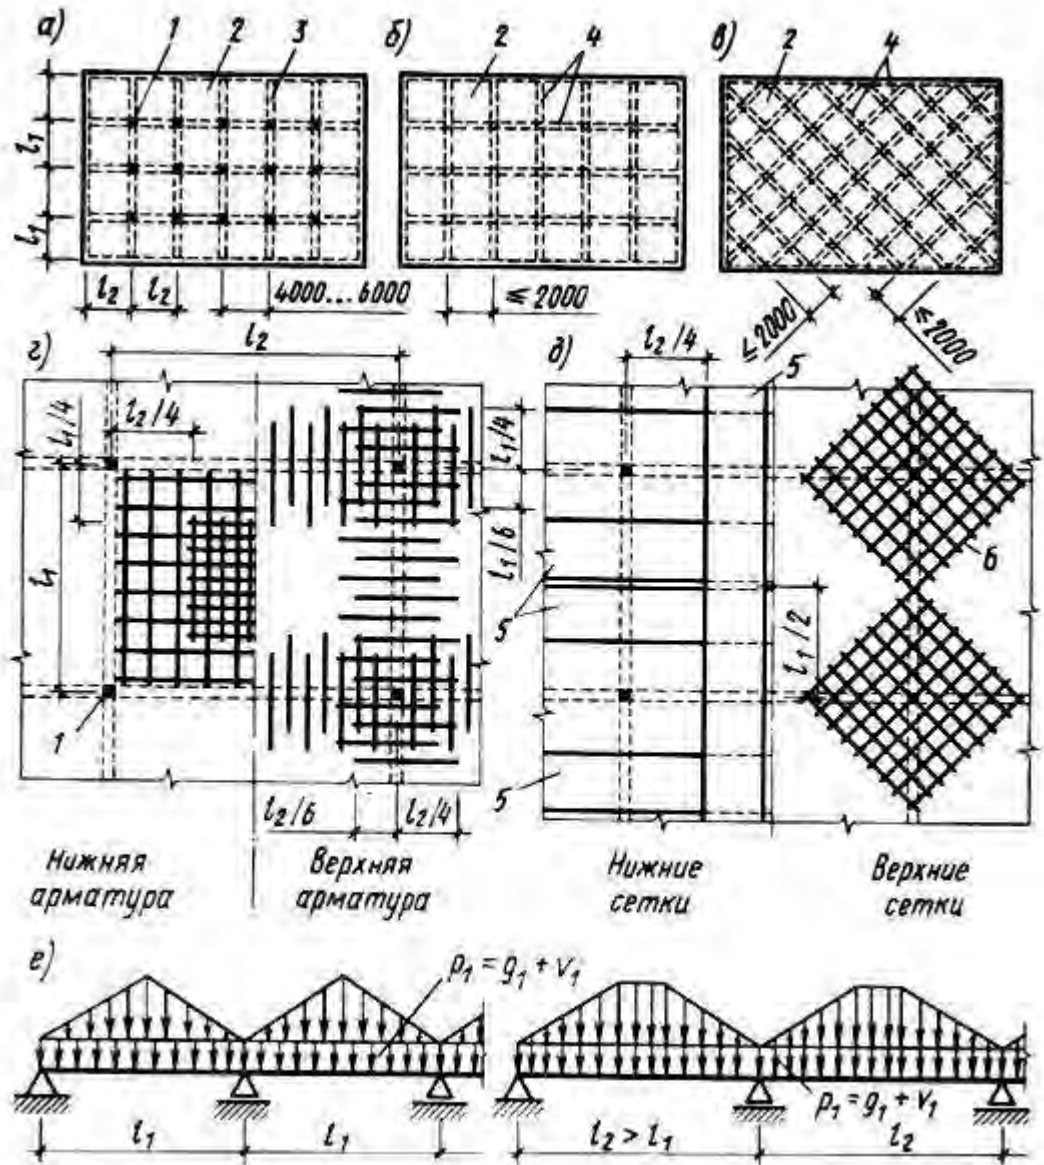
Конструктивное решение ребристых перекрытий с плитами опертыми по контуру (а, б, в), армирование плит плоскими (г) и рулонными (д) сетками, а также схемы нагружения балок (е)
